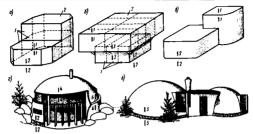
Примерные схемы нествидартных решений малоэтажных жилых домов из монолитного бетова:
